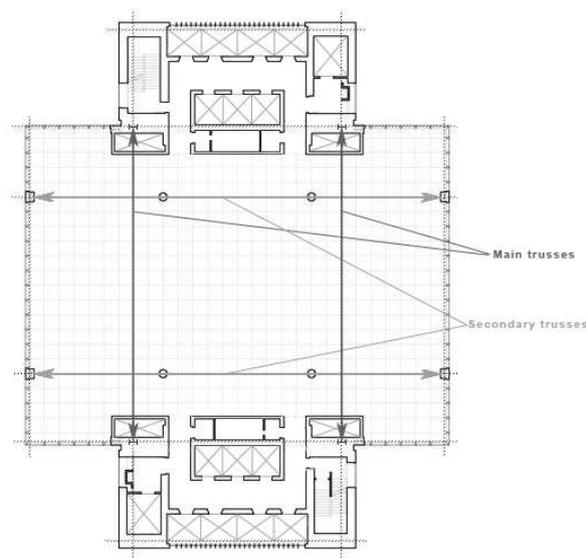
Planta tipo torre Bankia con la proyección de las cerchas.
